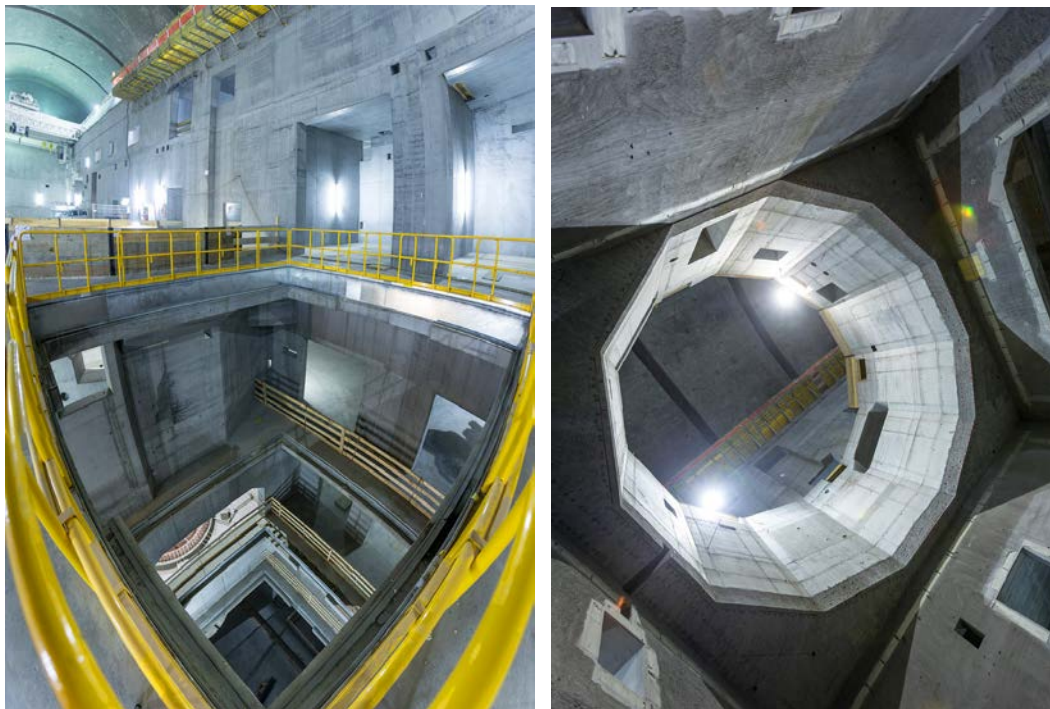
Betonstruktur nach Abschluss der Erstbetonarbeiten (Foto: NDD)
